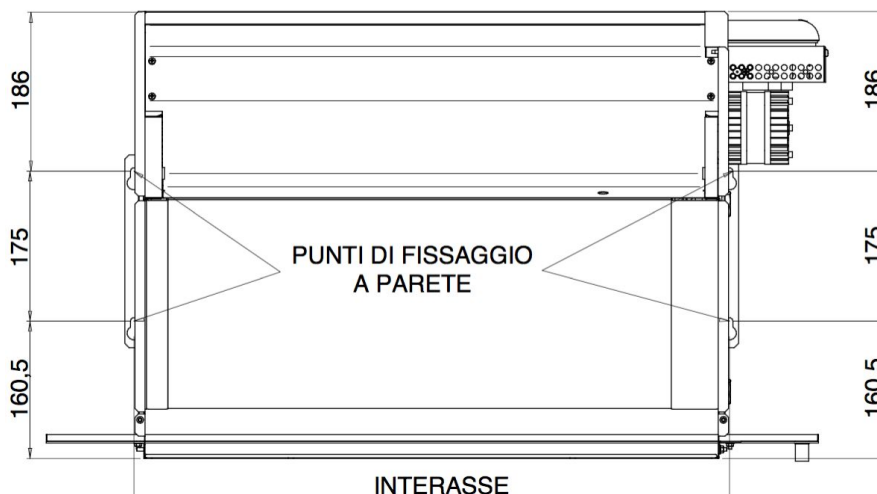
Posizione e dettaglio dei fissaggi a alla struttura ad incasso.
